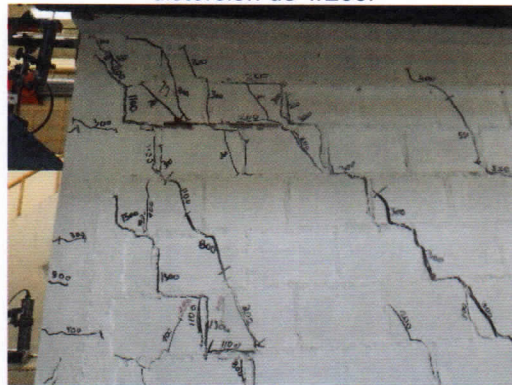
Formación de grietas diagonales en la parte superior Oeste de la cara Sur para una distorsión de 1/200.
